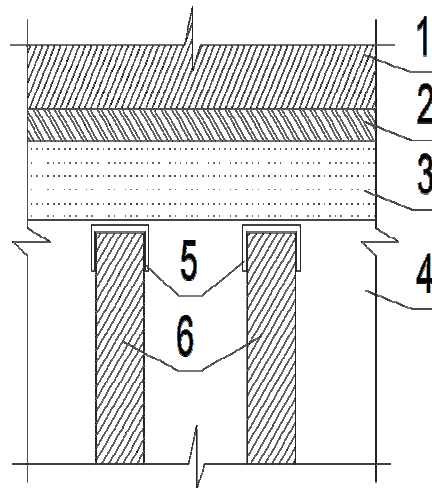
Свайный фундамент с промежуточной «подушкой».
